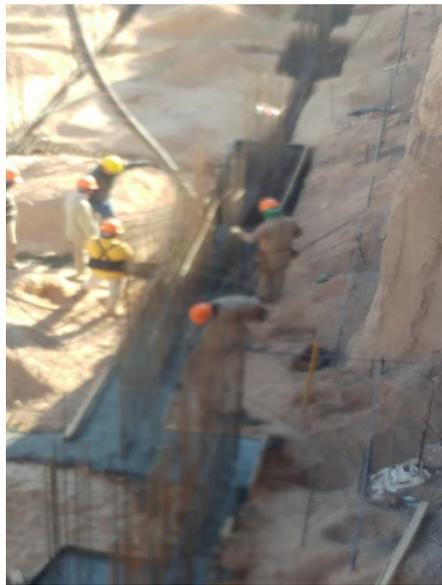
Imagen de Hormigonado de Fundaciones
